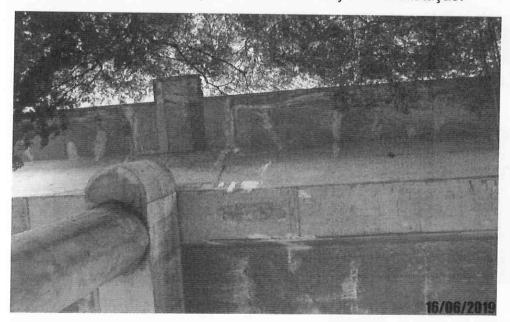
Detalhe da face inferior da viga e do tabuleiro com armadura exposta, eflorescência e desplacamento de concreto.
